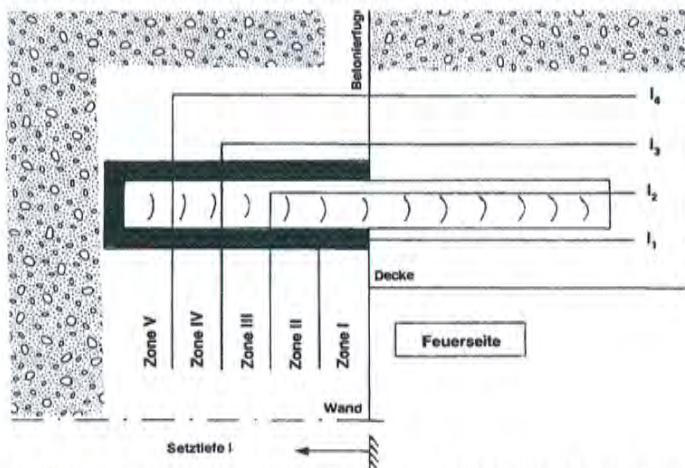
Schematische Darstellung der Bewehrungsanschlussvariante „Verankerung“
